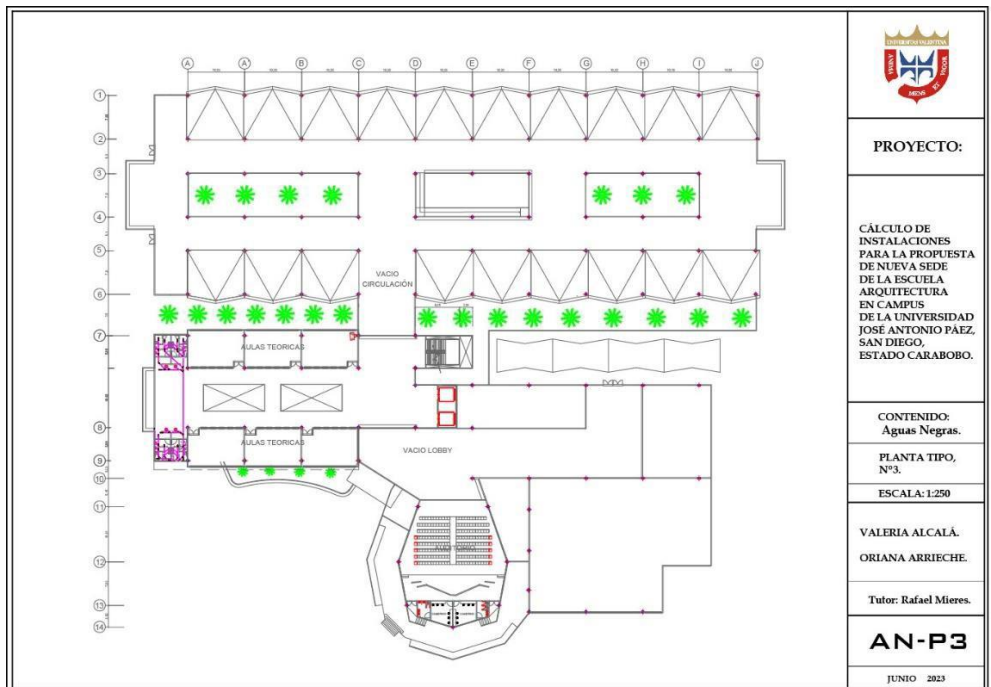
Distribución de aguas negras planteadas, planta tipo Numero 3.
